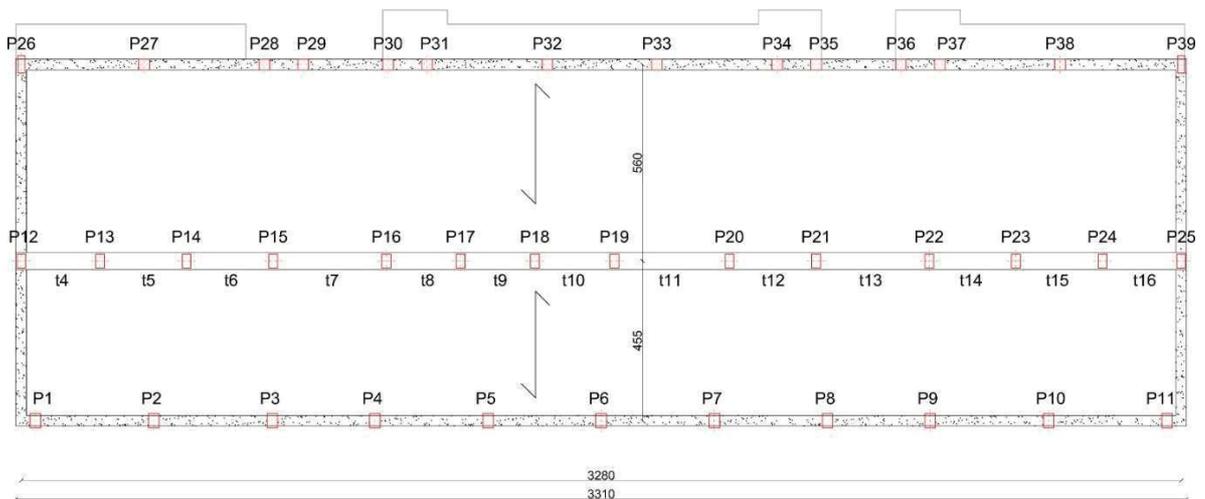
Pianta piano rialzato ricostruita – pilastri, travi e muro di sostegno
